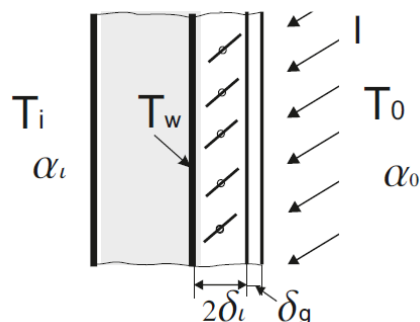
Расчетная схема стенки с ЭО для осенне-зимнего периода
